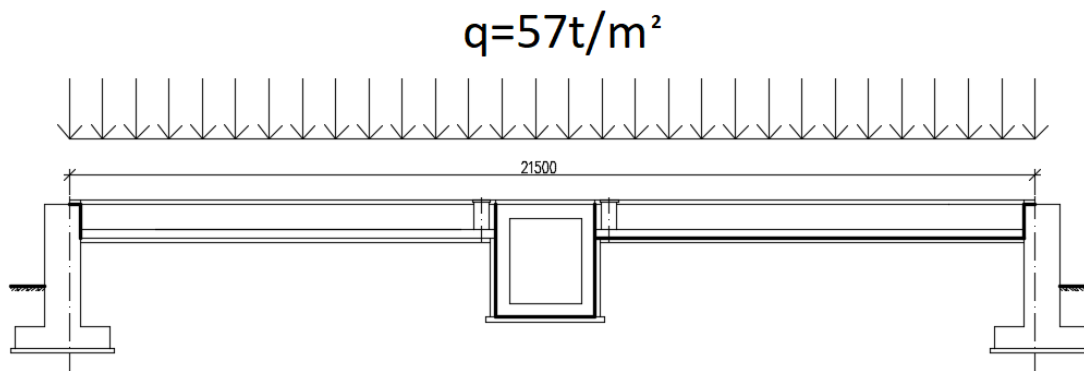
Схема фундаменту ФМ 1-1, і навантаження які на нього задаються
